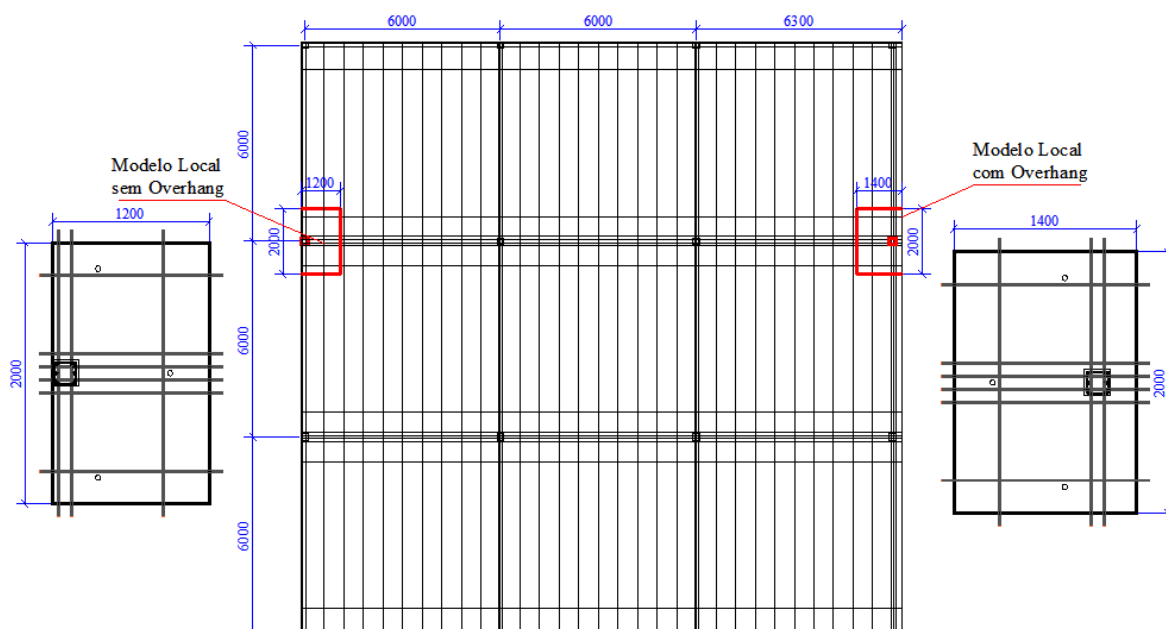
Disposição dos cabos em um pavimento completo de laje lisa protendida.
